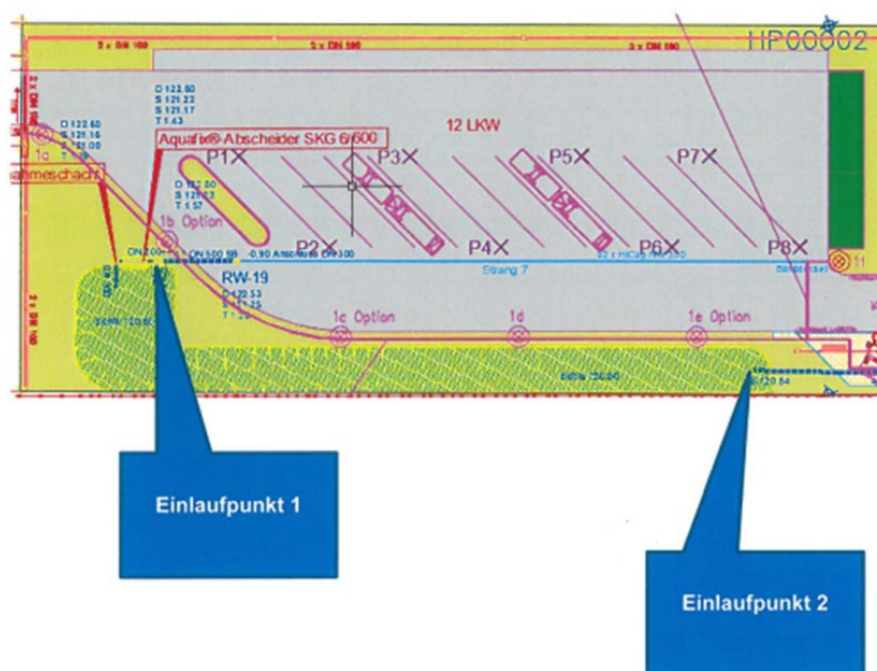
Lageplanskizze von Mulde Zufahrt (MZ; Einlaufpunkt 1) und Mulde Ladefläche (ML; Einlaufpunkt 2). Quelle: Prüfbericht Fader Umweltanalytik.
